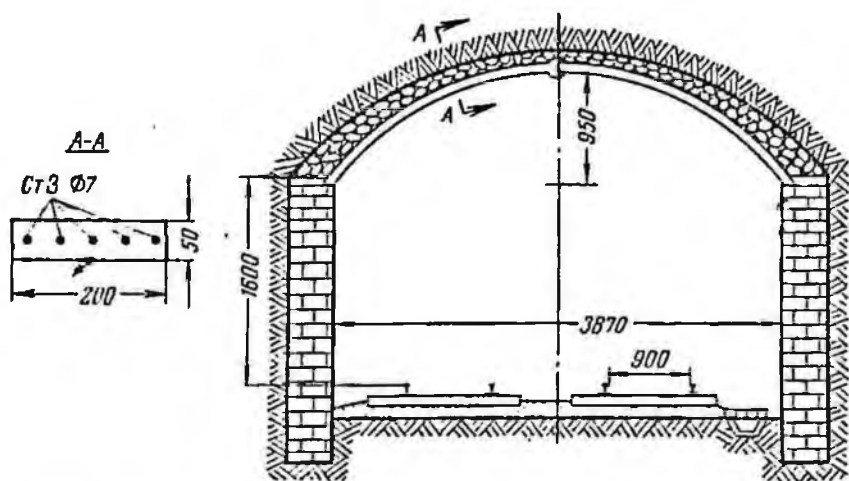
Смешанная крепь с тонкостенным арочным сборным железобетонным перекрытием
